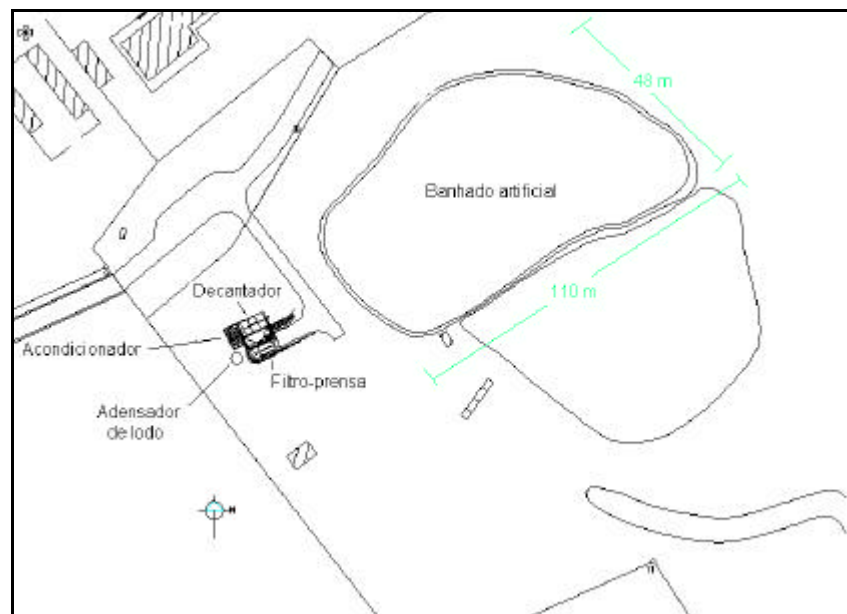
Planta de instalação da estação de tratamento de efluentes.
